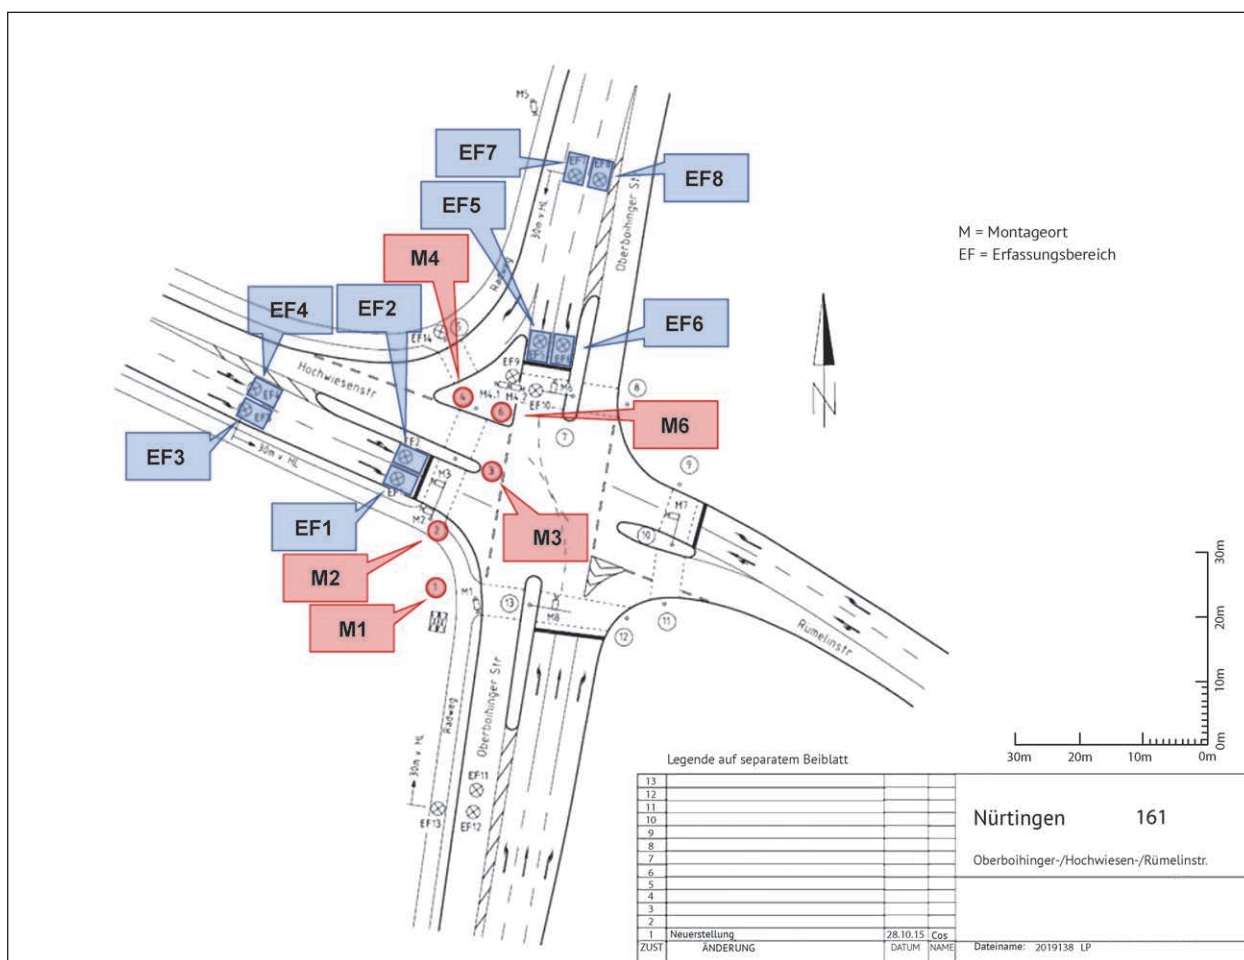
Lageplan mit relevanten Montageorten und Erfassungsbereichen
